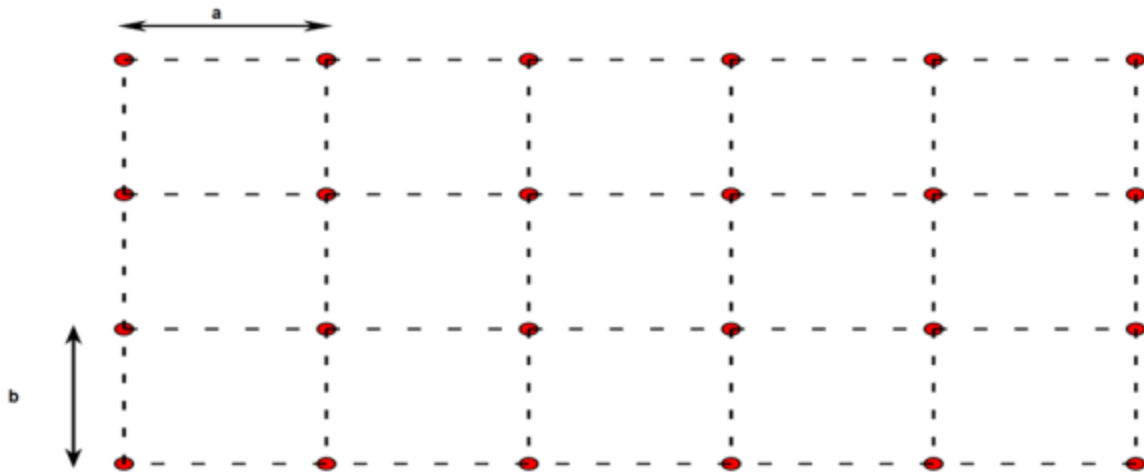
Plans de chevillage en plein de panneaux de dimensions 800 x 620 mm
